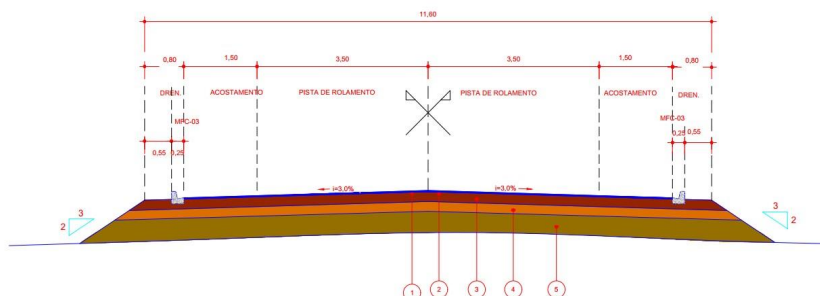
Seção-tipo de Pavimentação em Aterro.
